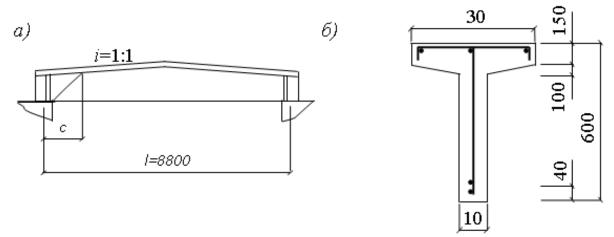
Схема опирания и размеры сечения двухскатной балки
